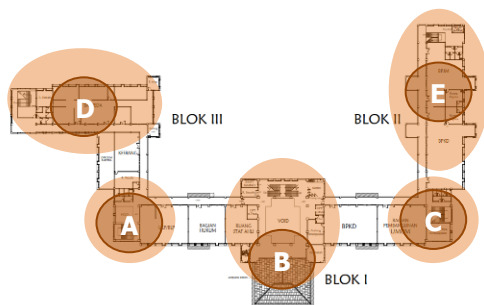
Titik Dampak Rembesan Pada Lantai I.
